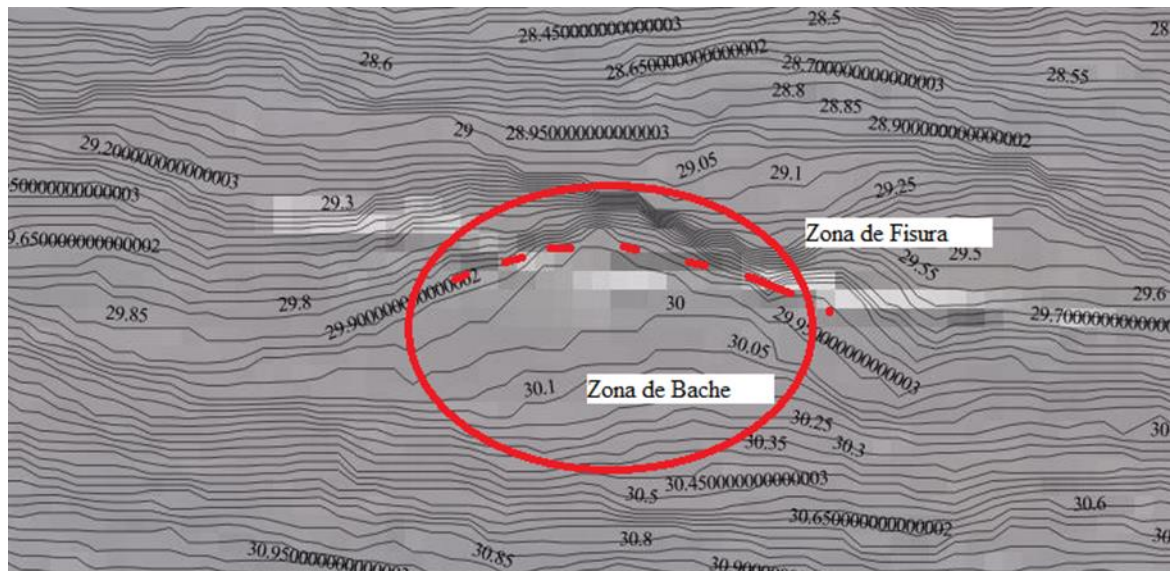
Fisuras y baches detectados preliminarmente mediante el modelo de elevación digital obtenido a través de ortofotografía de dron (50 m de altura).
